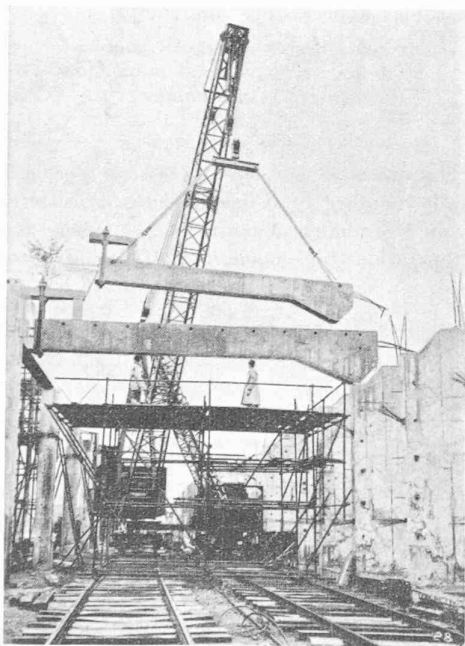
Chantier de la galerie couverte de Rouen : mise en place d'une poutre transversale.
